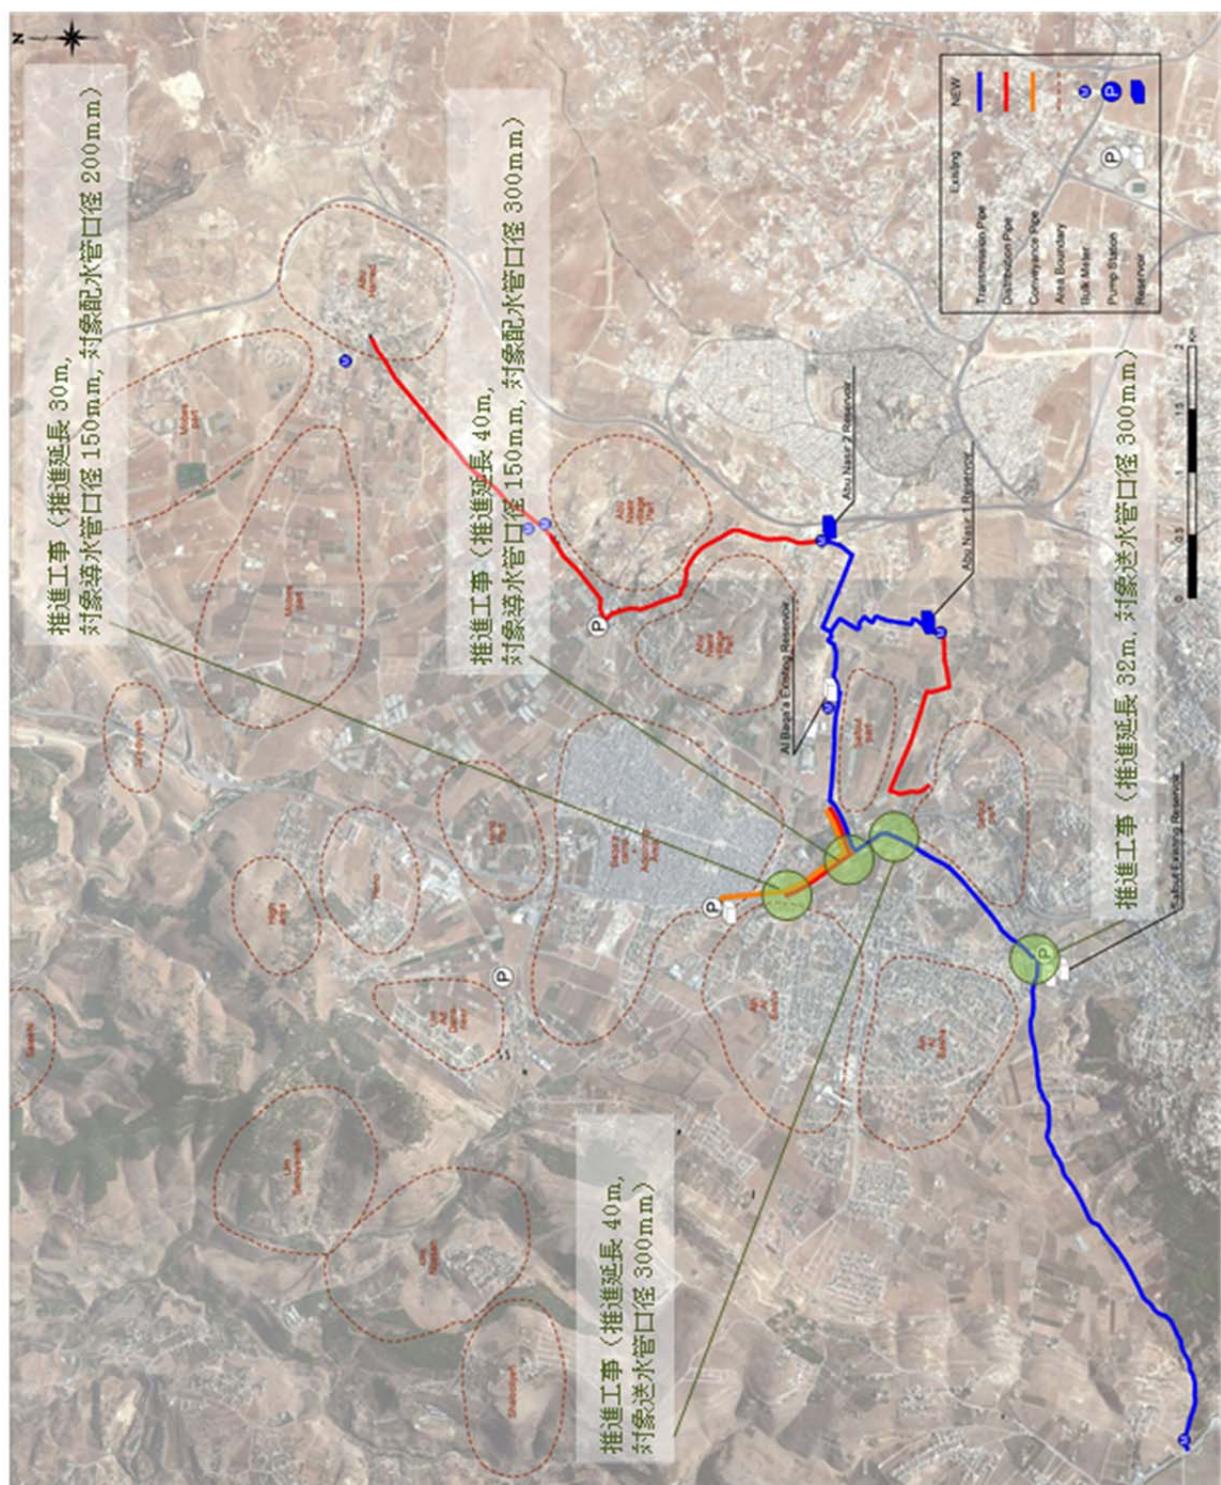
非開削工法による配水管工事の施工個所（インアルバシャ）
